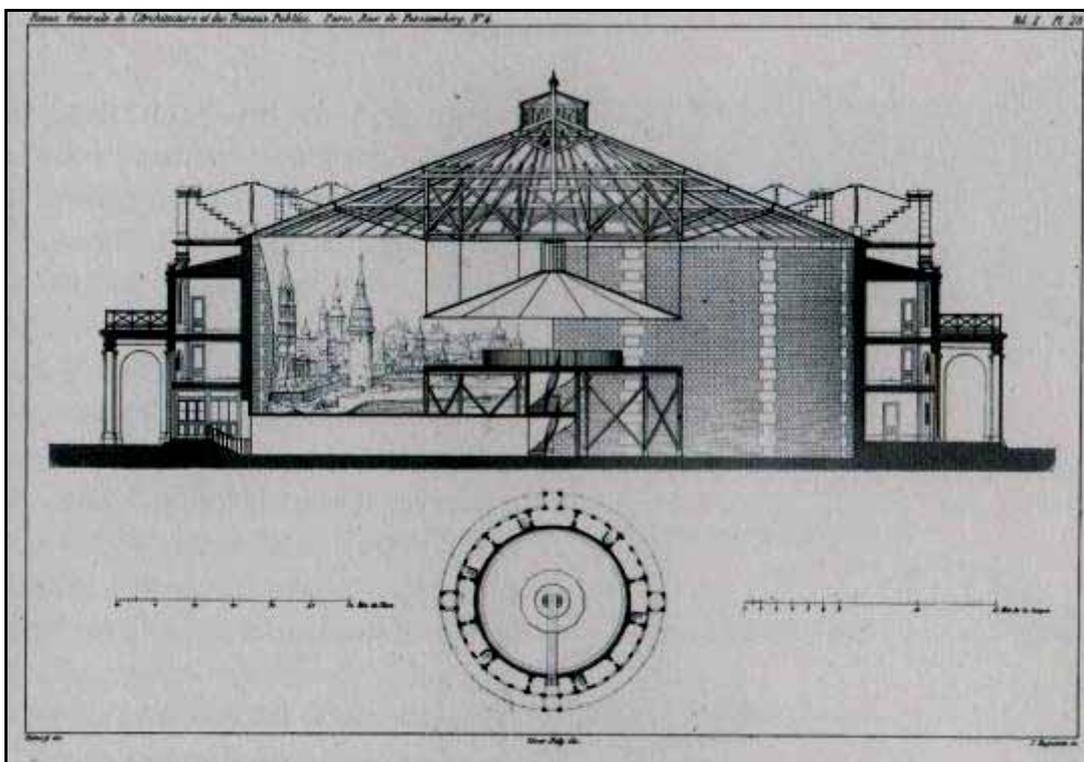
Corte esquemático e planta da plataforma do projeto do arquiteto Hittorff.
